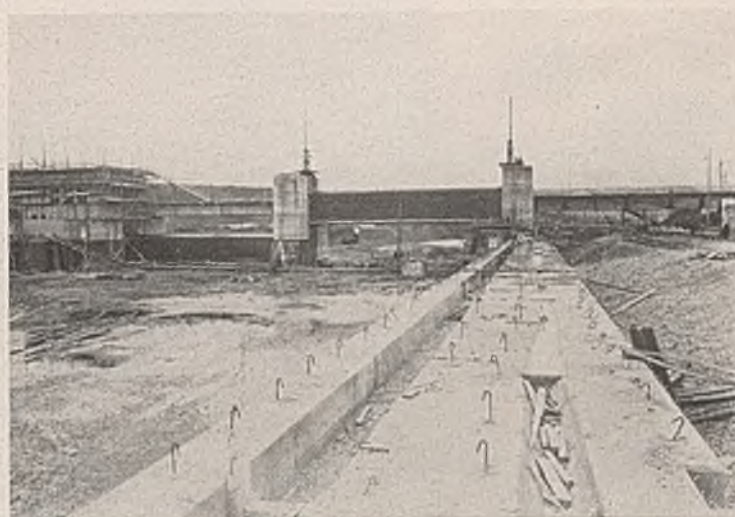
Staustufe Aldingen. Schützenwehr mit Eisenbetonbrücke. Kraftwerk links, flußseitige Schleusenmauer rechts. Oberwasserseite.
